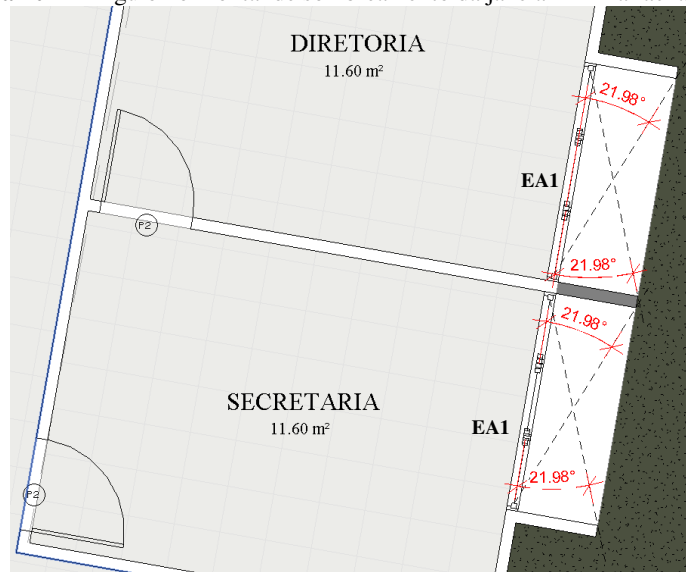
Ângulo horizontal de sombreamento da janela EA10 na fachada leste
